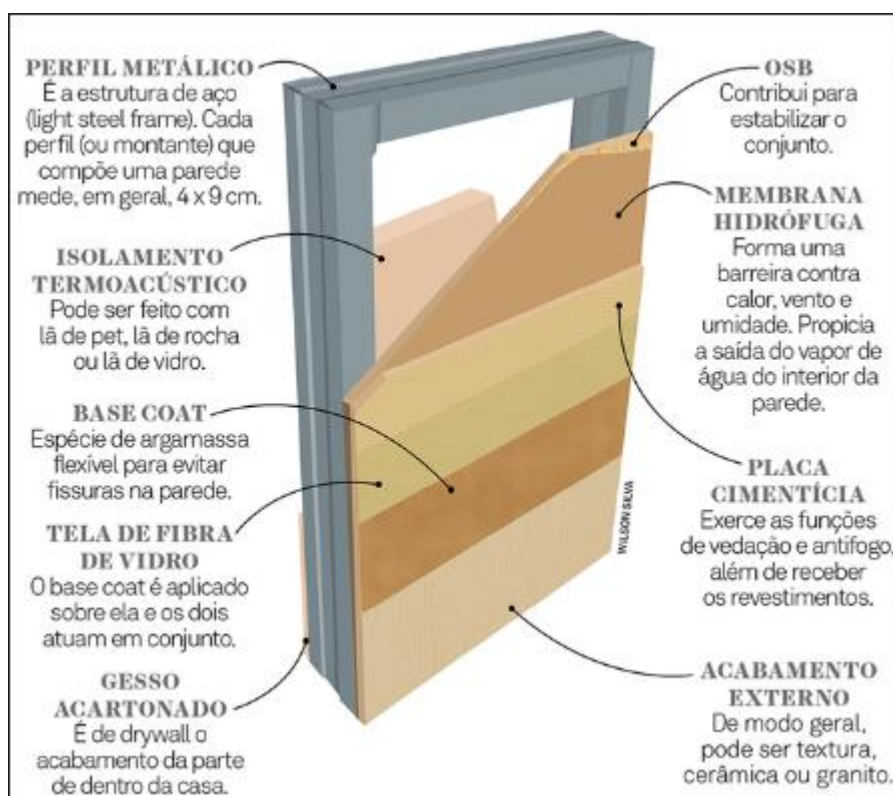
Desenho esquemático do fechamento interno e externo do sistema LSF (Fonte: LP- BUILDING PRODUCTS, 2017).
